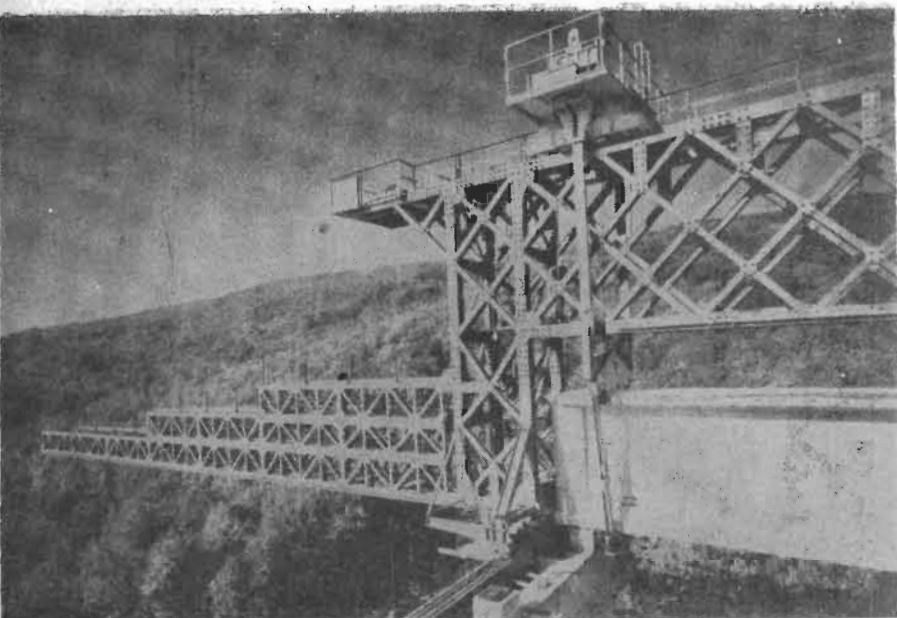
Puente Pfädschensgraben con equipo de montaje durante la colocación de una viga.
